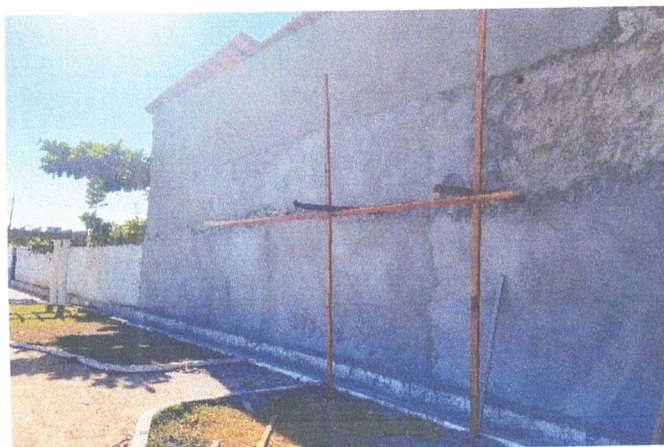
Execução de Chapisco, Reboco do Muro e
